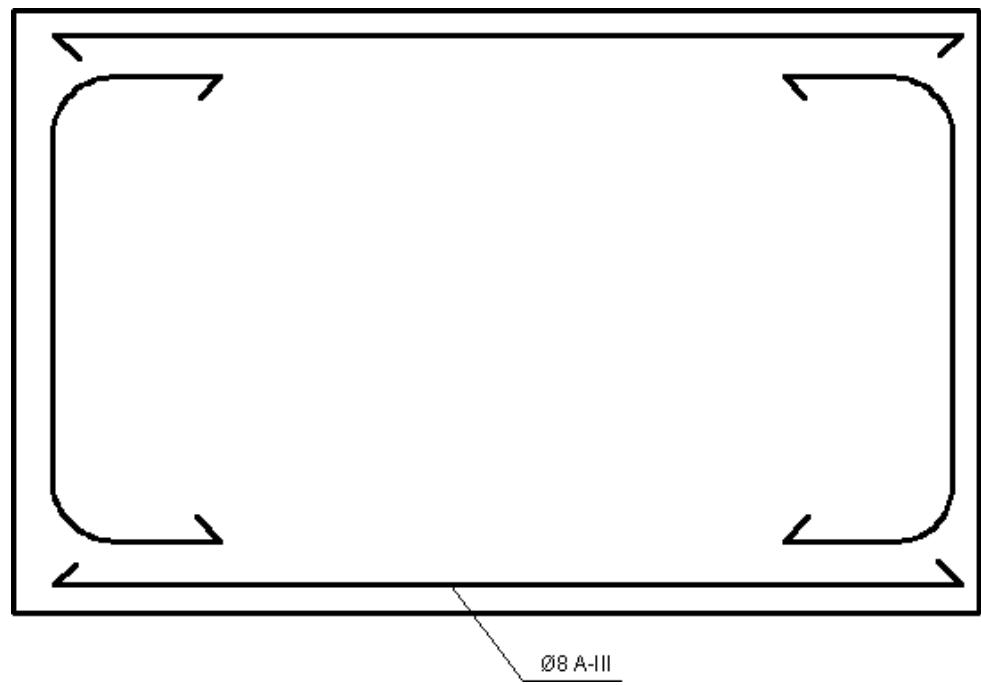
Армирование стеновой панели кольцевой арматурой
